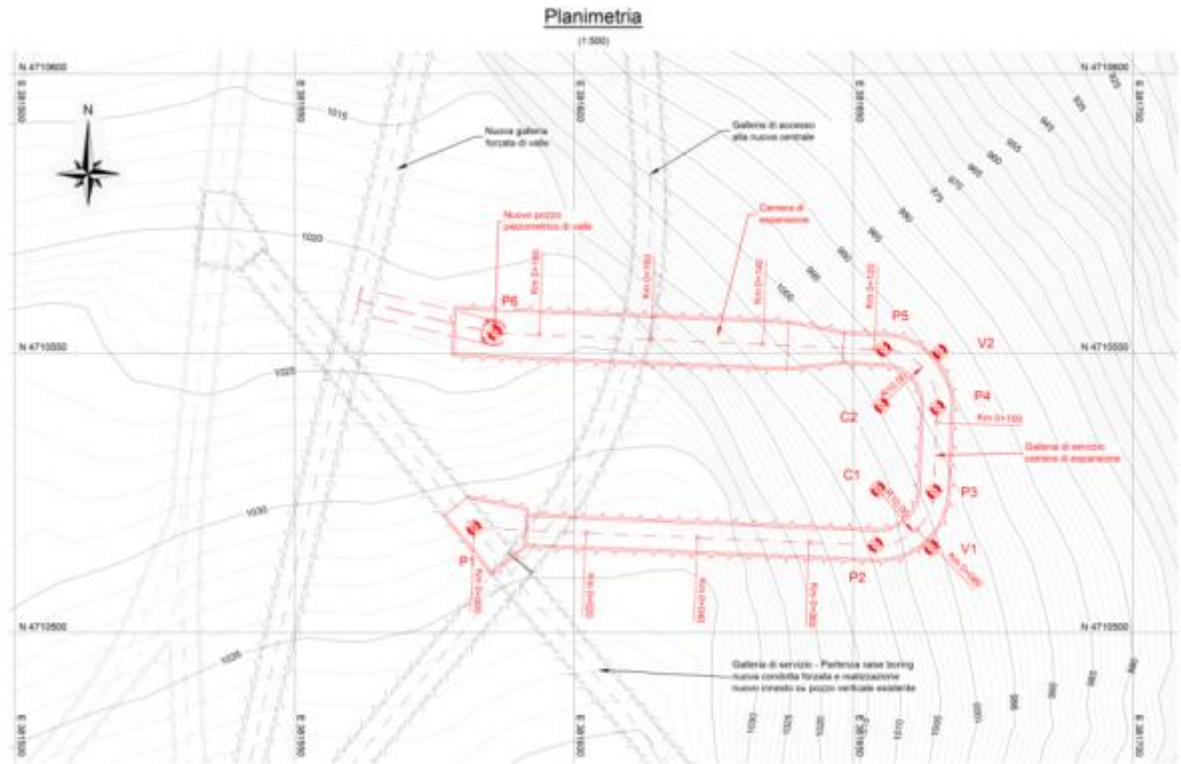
Nuovo pozzo piezometrico sulla derivazione Piaganini – pianta
